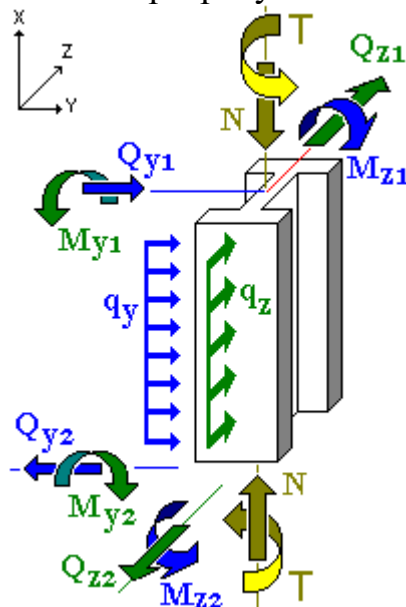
Розрахункова схема колони 1-го поверху.
